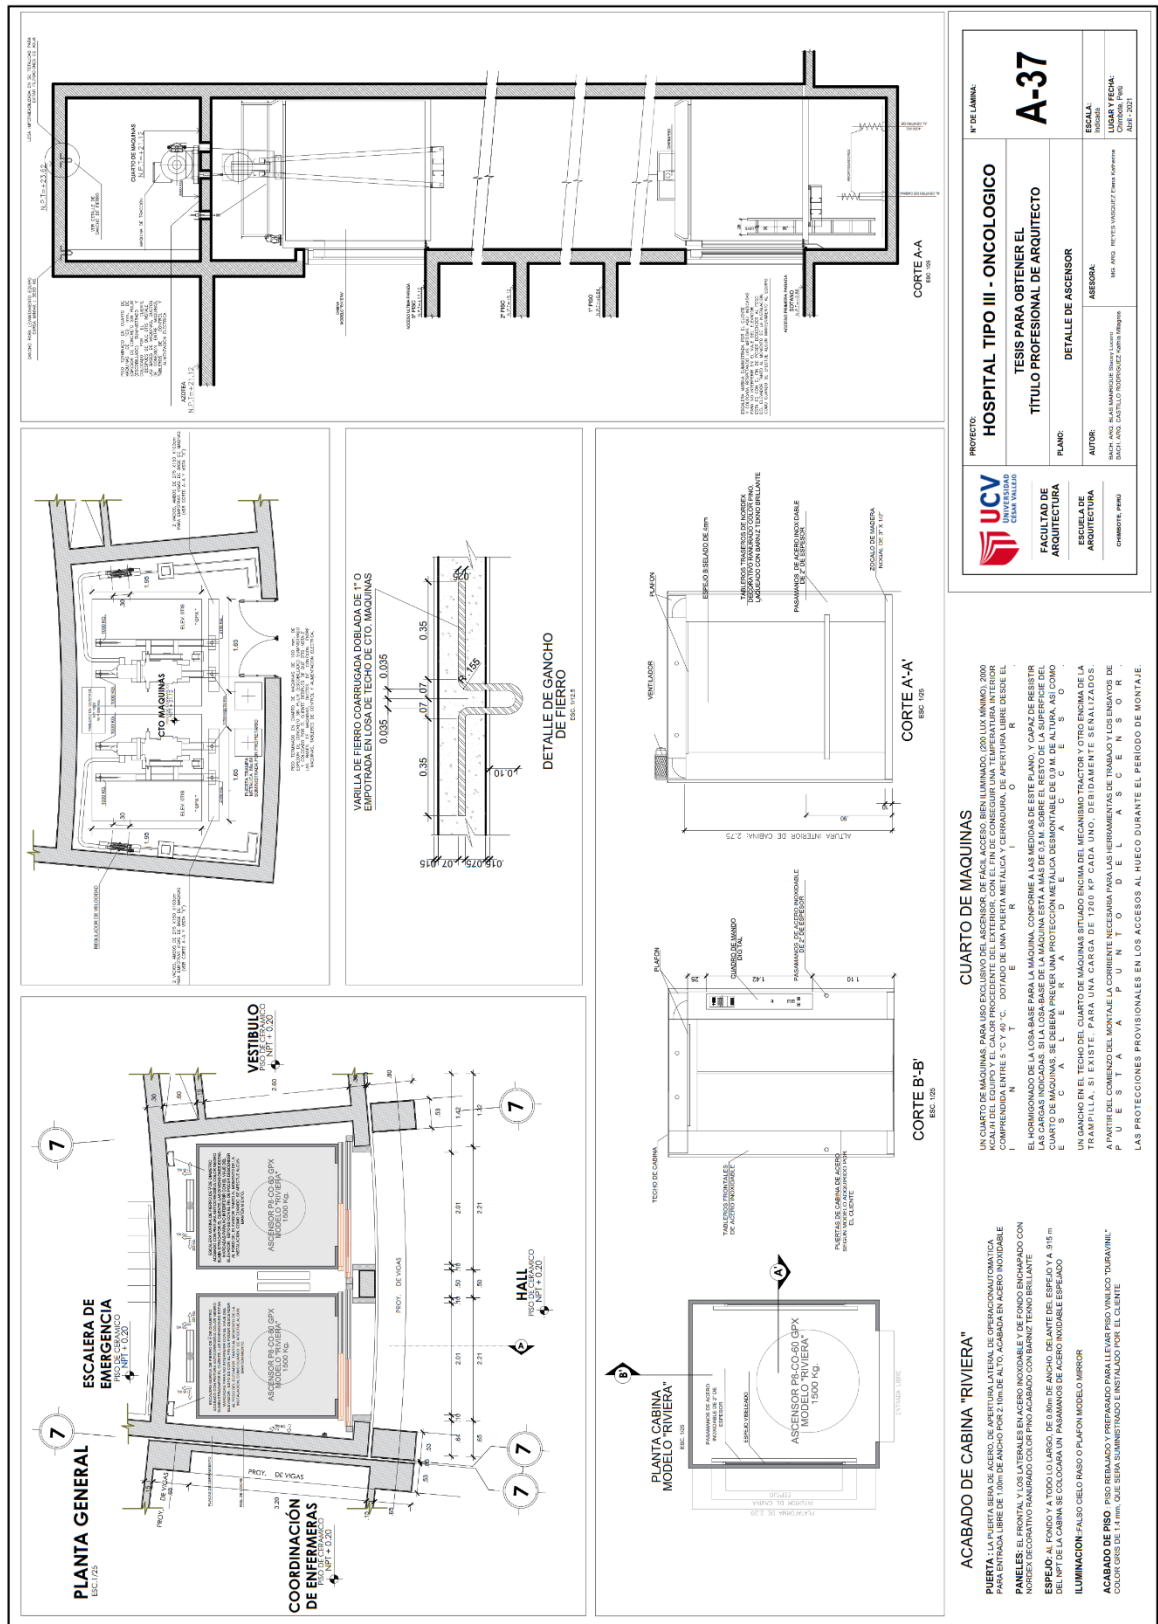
Plano de Detalle Constructivo - Ascensor
